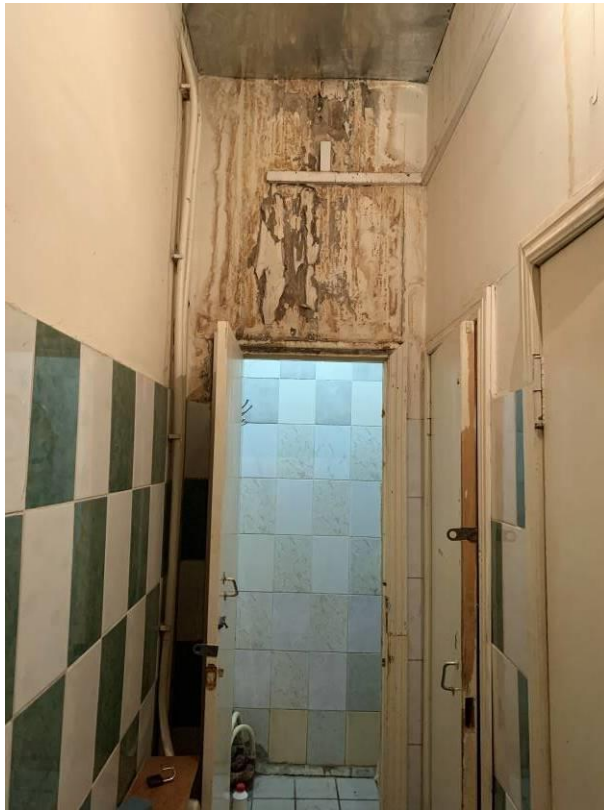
Санузел в осях 4-7/Е-Д в уровне 1-го этажа
